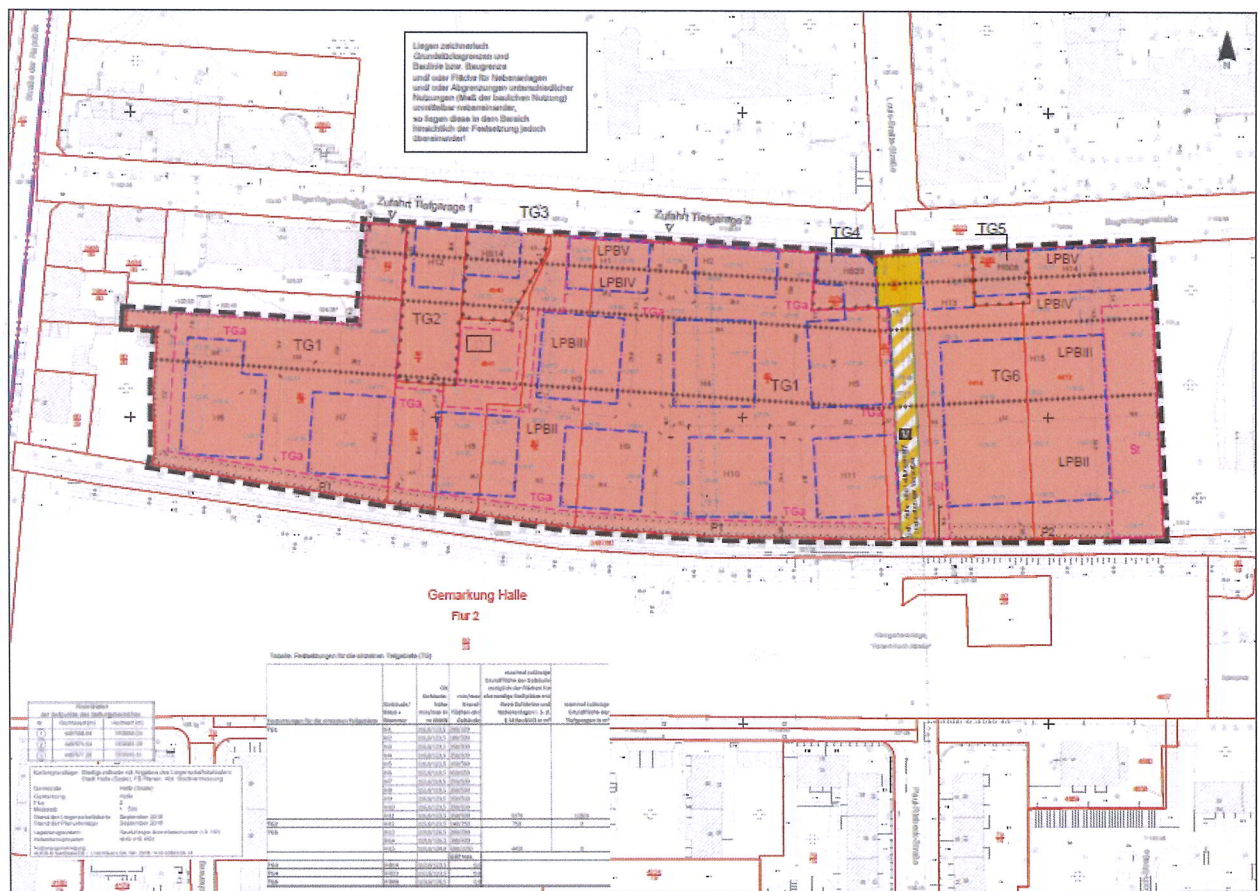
Lageplan mit Grenzen des räumlichen Geltungsbereiches des B-Plans
